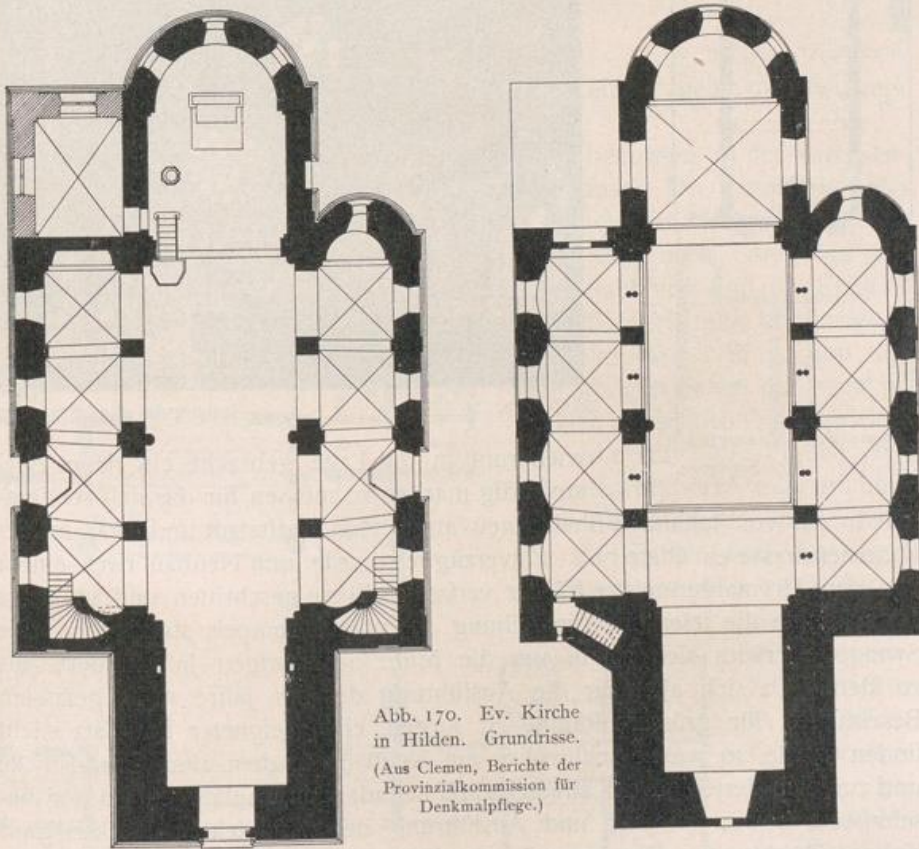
Ev. Kirche in Hilden. Grundrisse.
